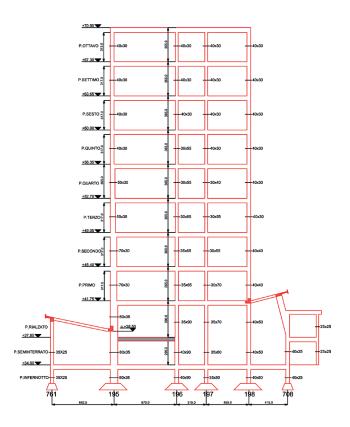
Sezione verticale (sezione A-A) da rilievo geometrico del progetto esecutivo.
